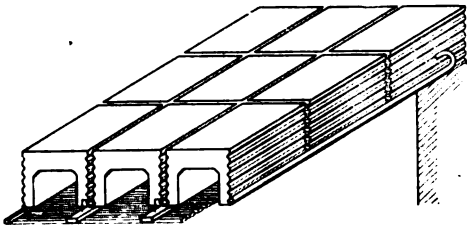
U-Steindecke mit Holzlatten-anstampfung zum Befestigen der Putzdecke.
